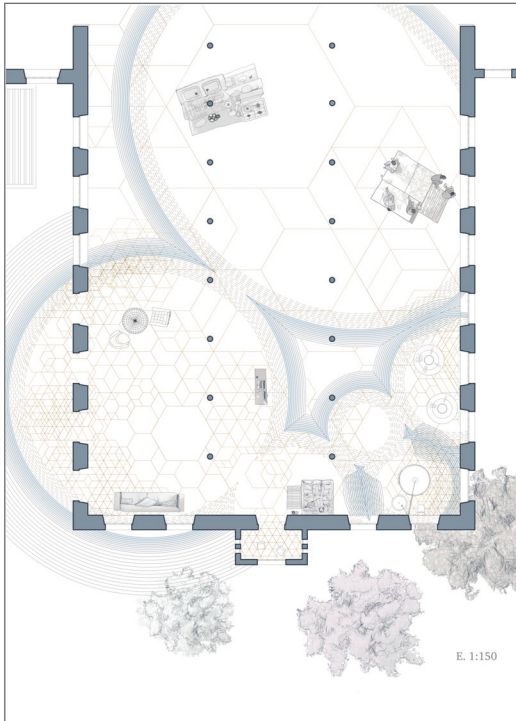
Planta intervención: proyecto de vivienda y espacio de diseño y producción
